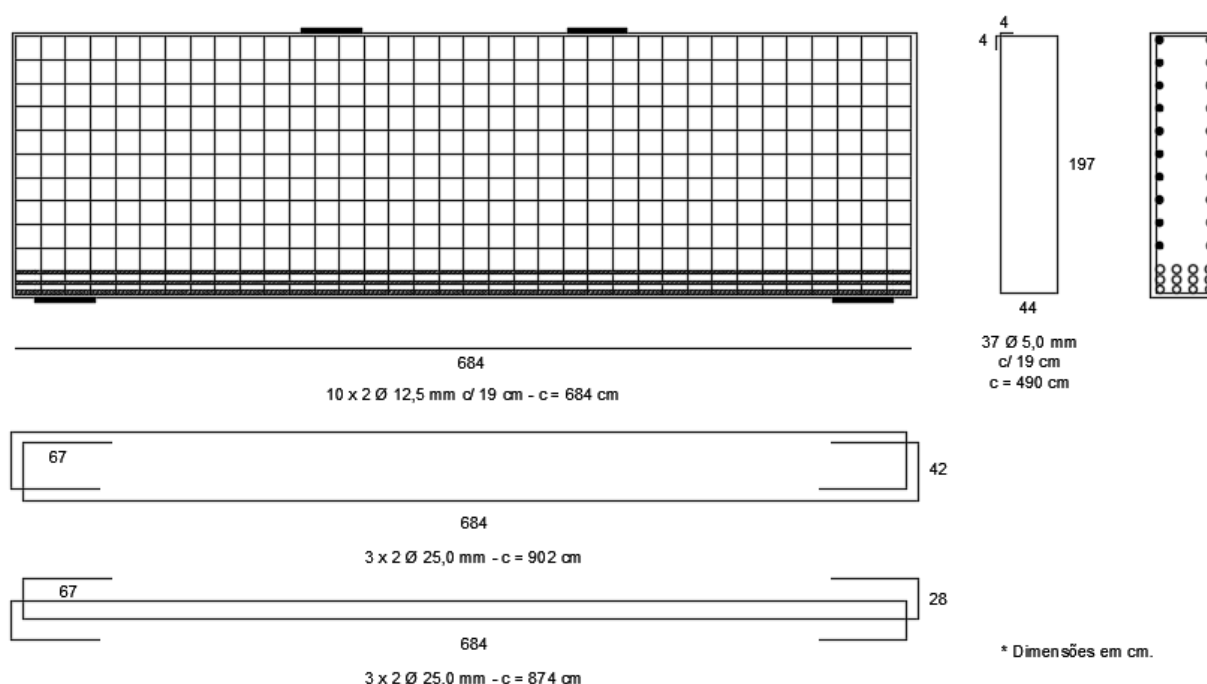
Detalhamento da armadura do modelo de viga-parede A, obtido com dimensionamento segundo ACI (2011)
